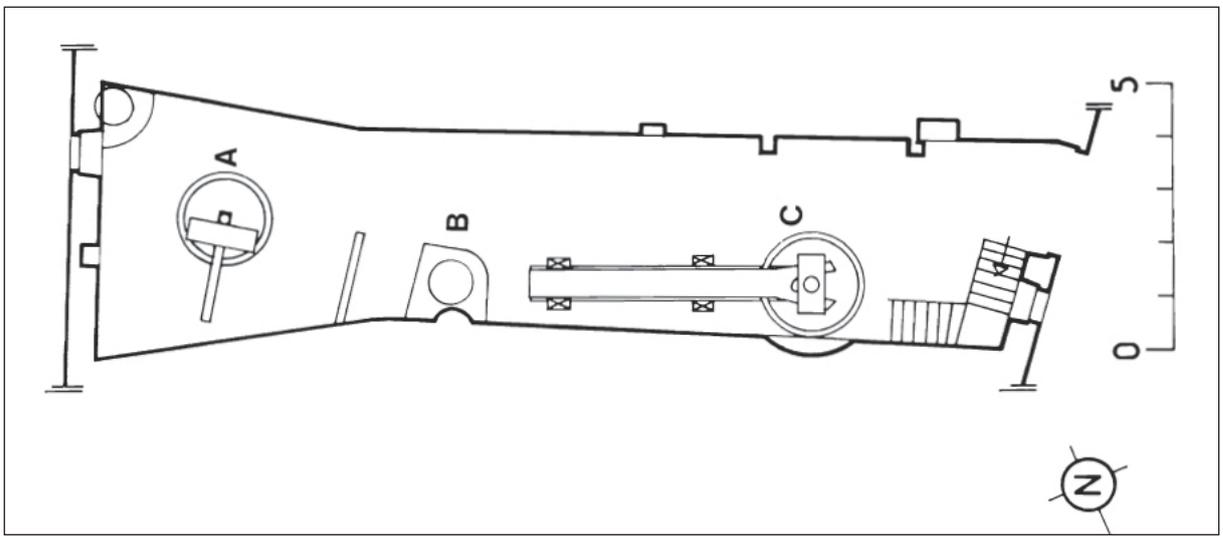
emplacement des structures du moulin au rez-de-chaussée
